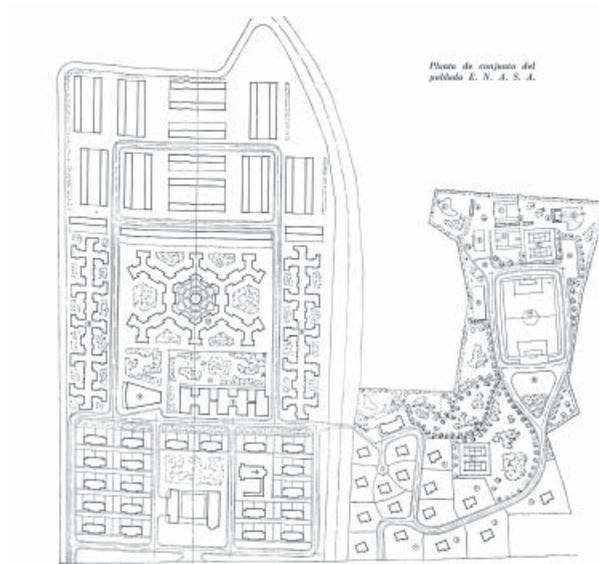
Plano de conjunto (solución descartada) Fuente: Revista Gran Madrid.
